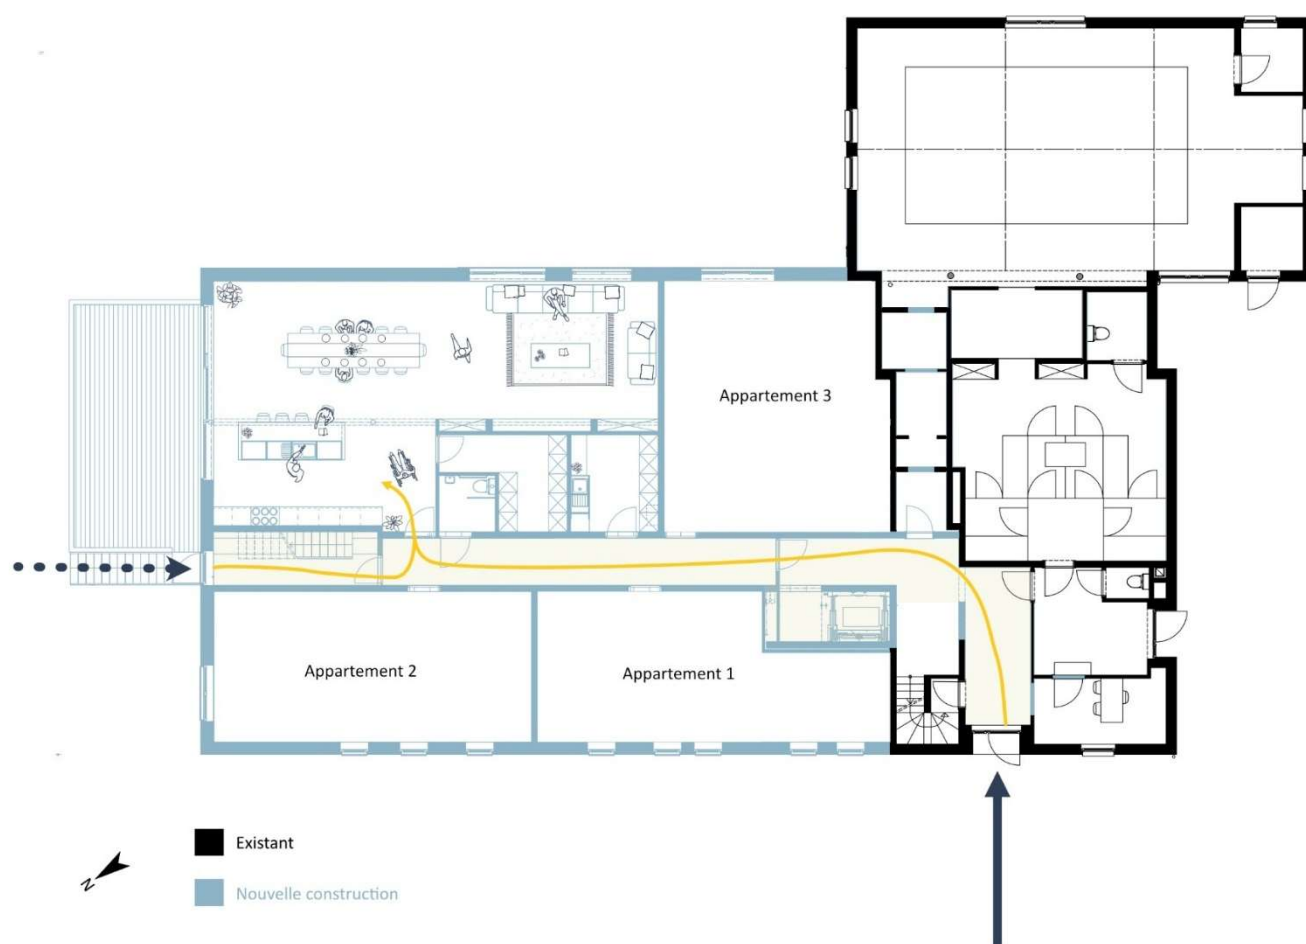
Plan des circulations au rez-de-chaussée – Maison L'Eau Vive
